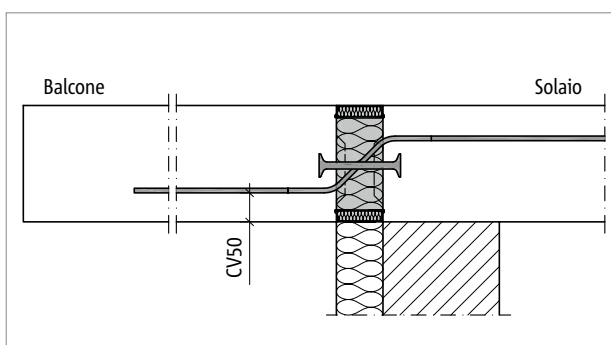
Schöck Isokorb® T tipo Q-P-CV50: sezione
